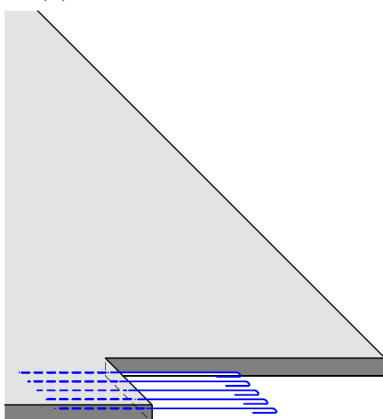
Flansch als Fertigteil mit Anschlussbewehrung
